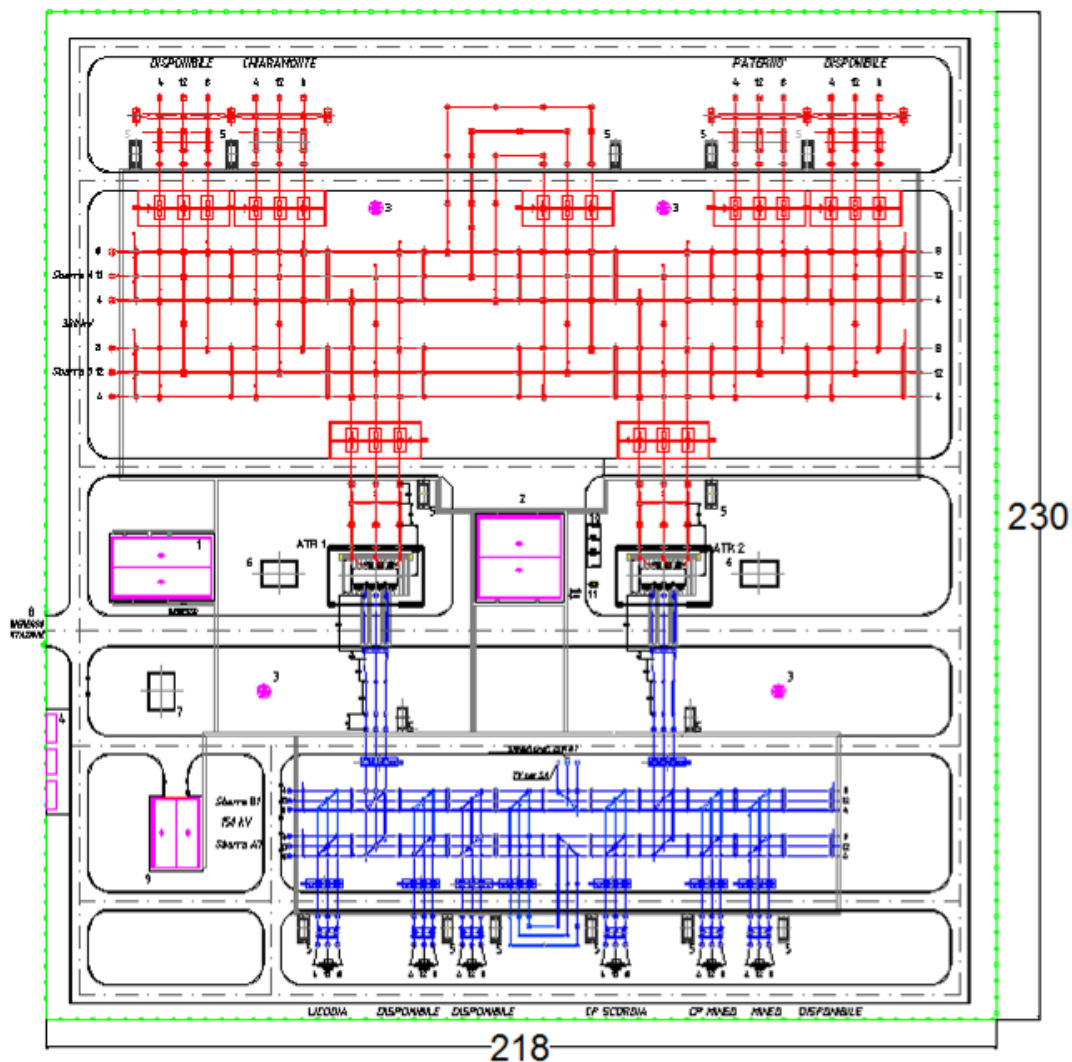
Planimetria generale elettromeccanica della futura SE di Vizzini
